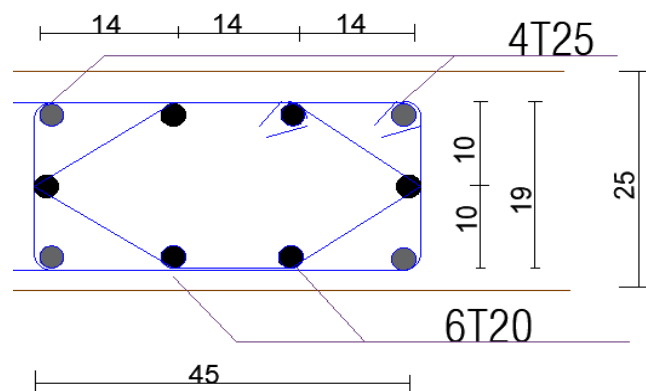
Ferrailage longitudinal des éléments de rive des voiles
